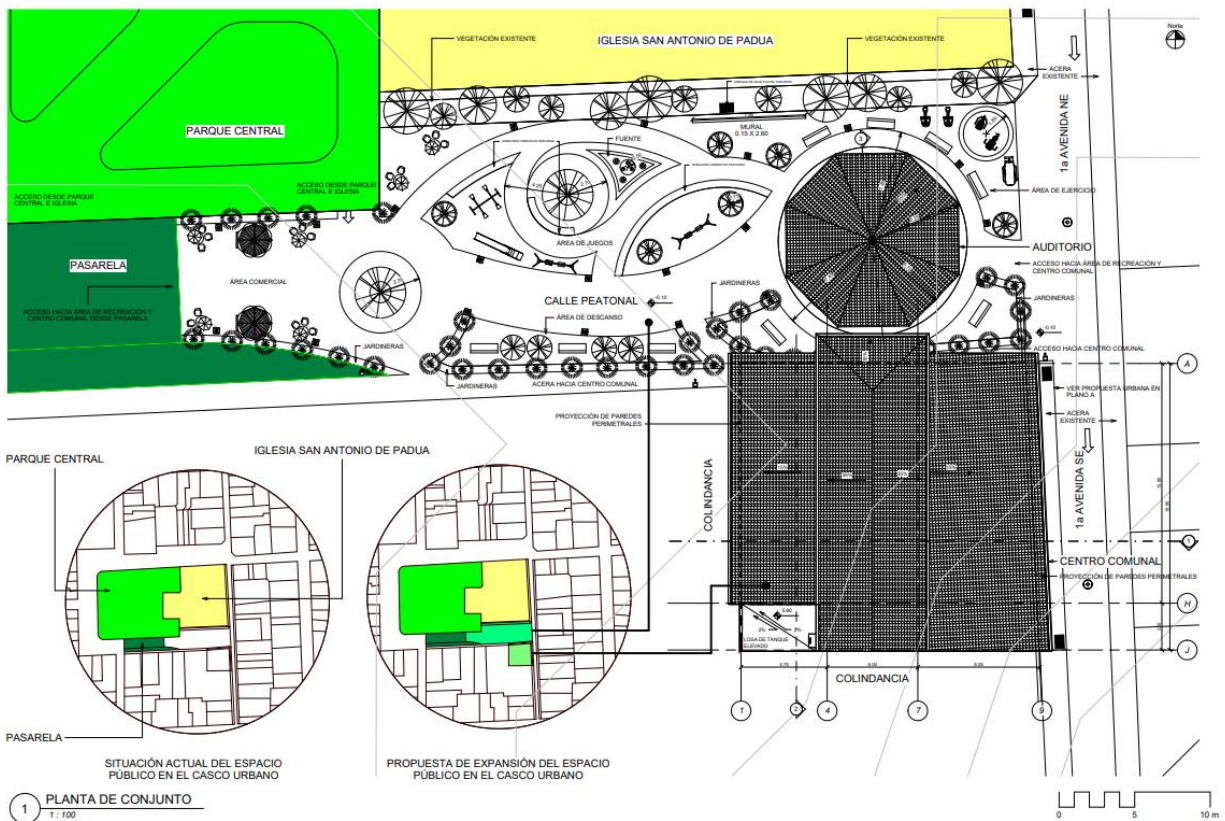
Propuesta Planta de Conjunto. Fuente: Elaboración propia
